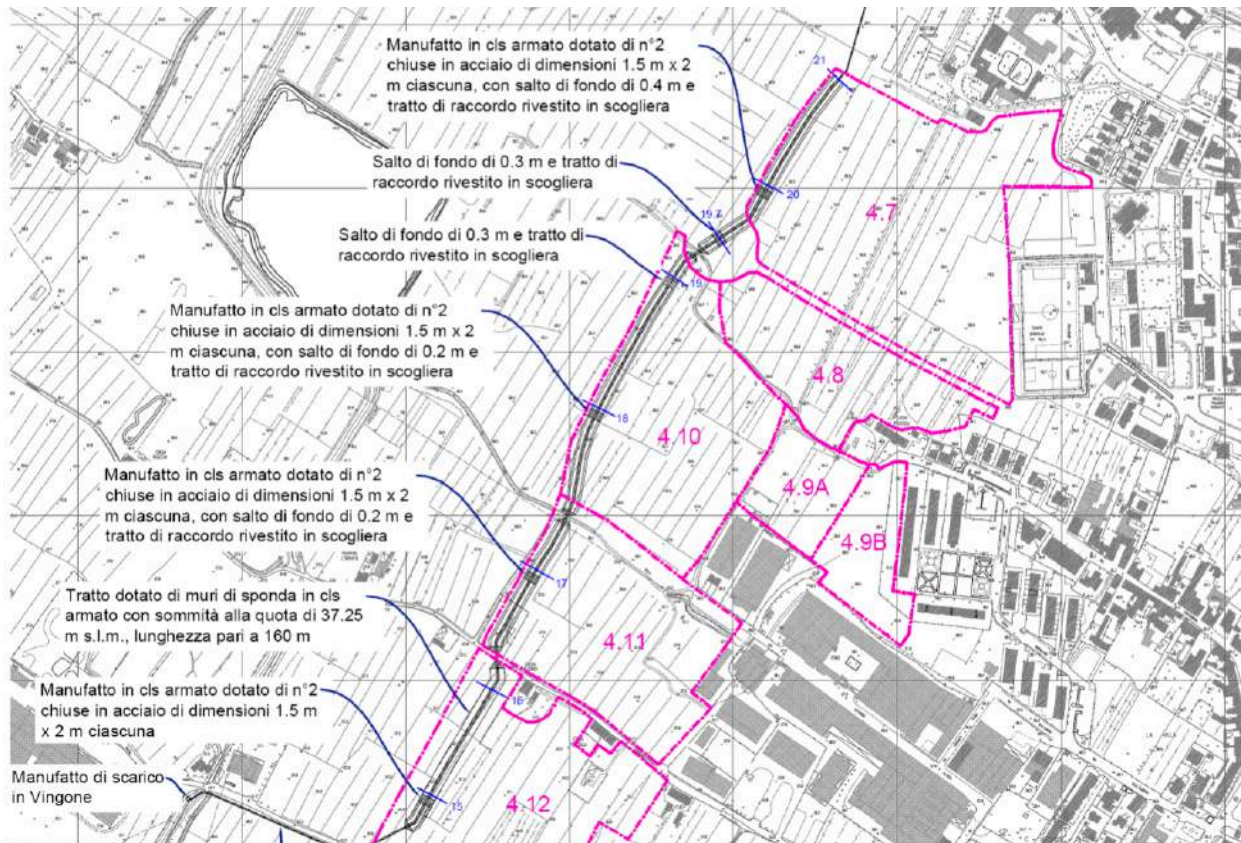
PLANIMETRIA INTERVENTI LOTTO FUNZIONALE 2
